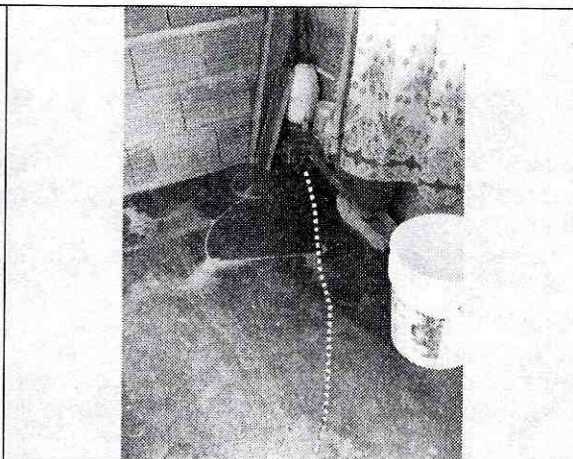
Fisuras en la losa de contrapiso del predio ubicado en la Calle 82A Sur # 44A - 32
